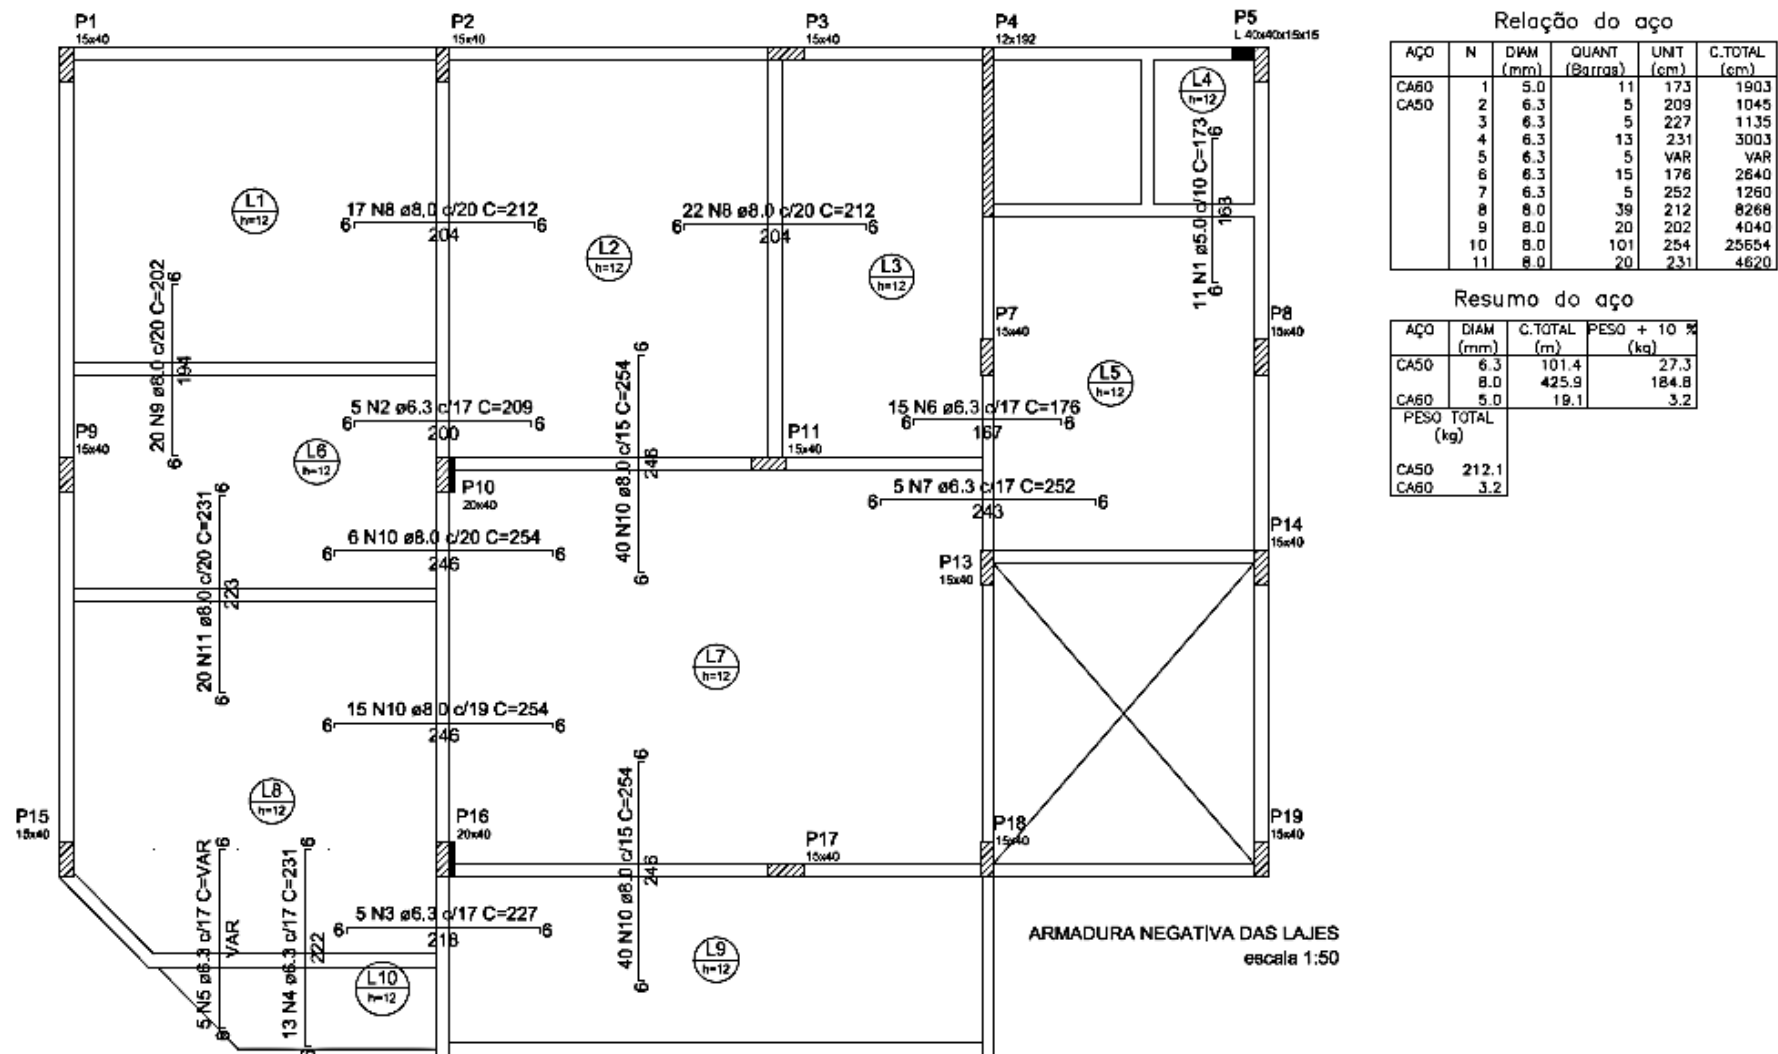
Detalhamento da armadura negativa das lajes segundo procedimentos manuais
